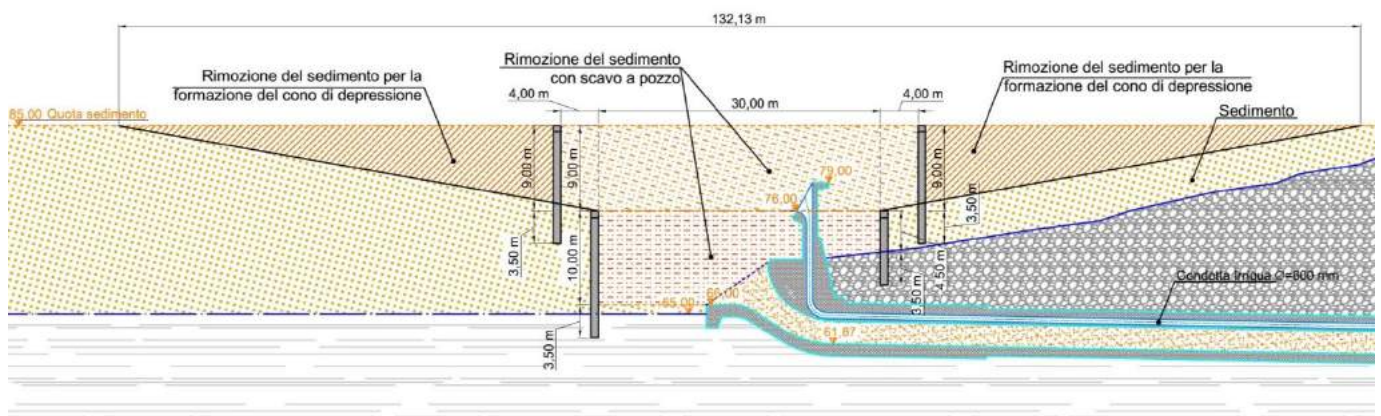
Sezione dell'imbocco scarico di fondo con indicazione delle paratie di pali e del sedimento da rimuovere
